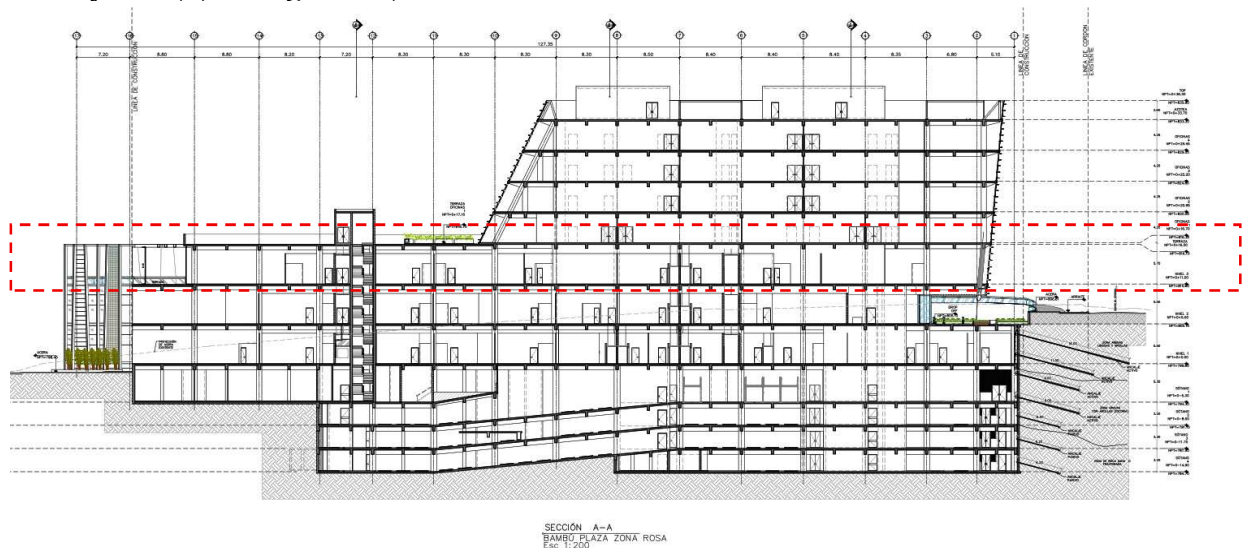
Plano Sección AA, Fuente: Elaboración Centro Comercial Bambú.
